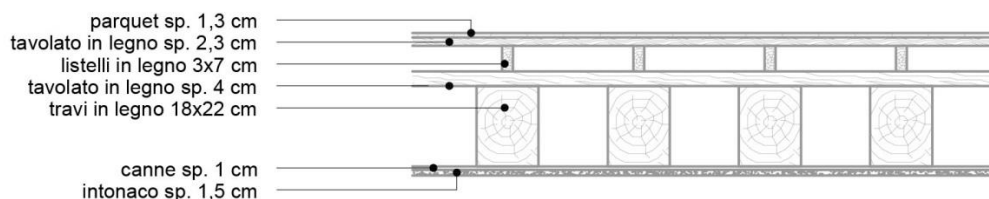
dettagli costruttivi per il solaio O.2A. Si ipotizza sia affine al solaio originale della Sala della Giunta, rilevato nel progetto Bellucco.
